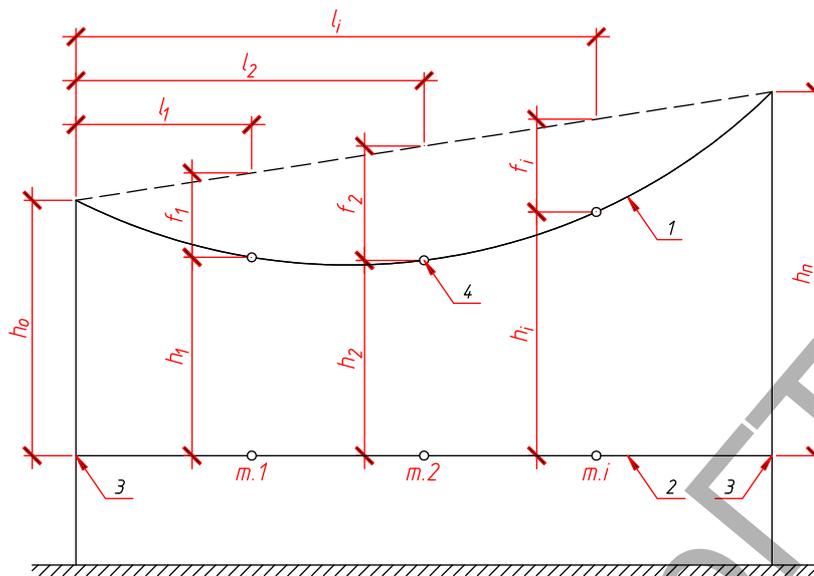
Схема определения прогиба перекрытия с помощью горизонтальной нити [6]:
